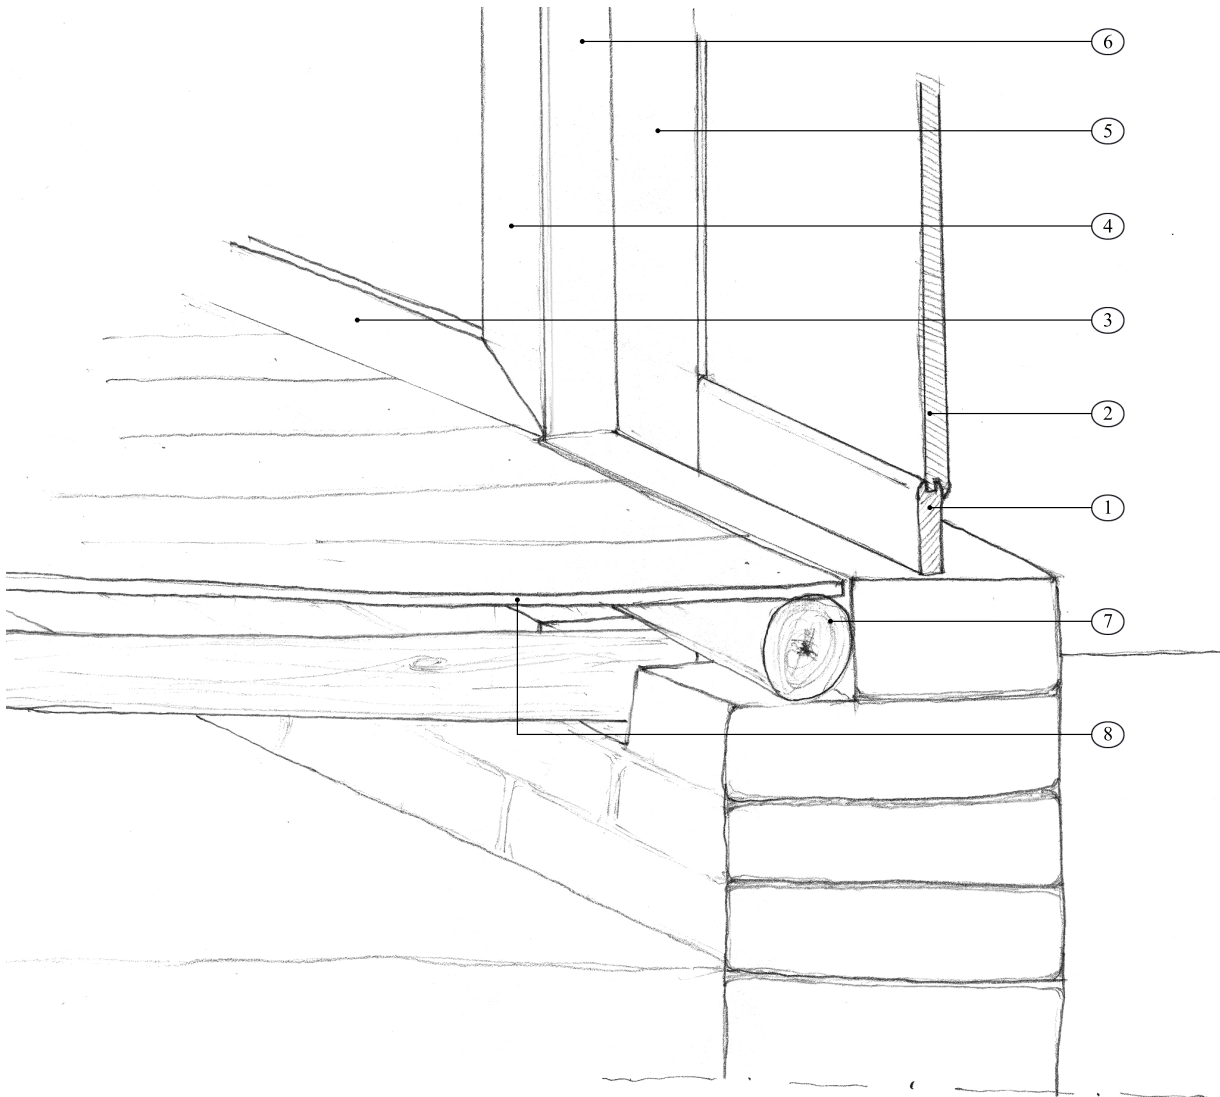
Pormenor tipo de porta e de estrutura do soalho. Legenda: 1 Travessa inferior da porta, 2 Almofada, 3 Rodapé, 4 Alizare / Mata juntas, 5 Couceira, 6 Aro, 7 Viga / Pau rolado da estrutura do soalho, 8 Soalho de madeira.
